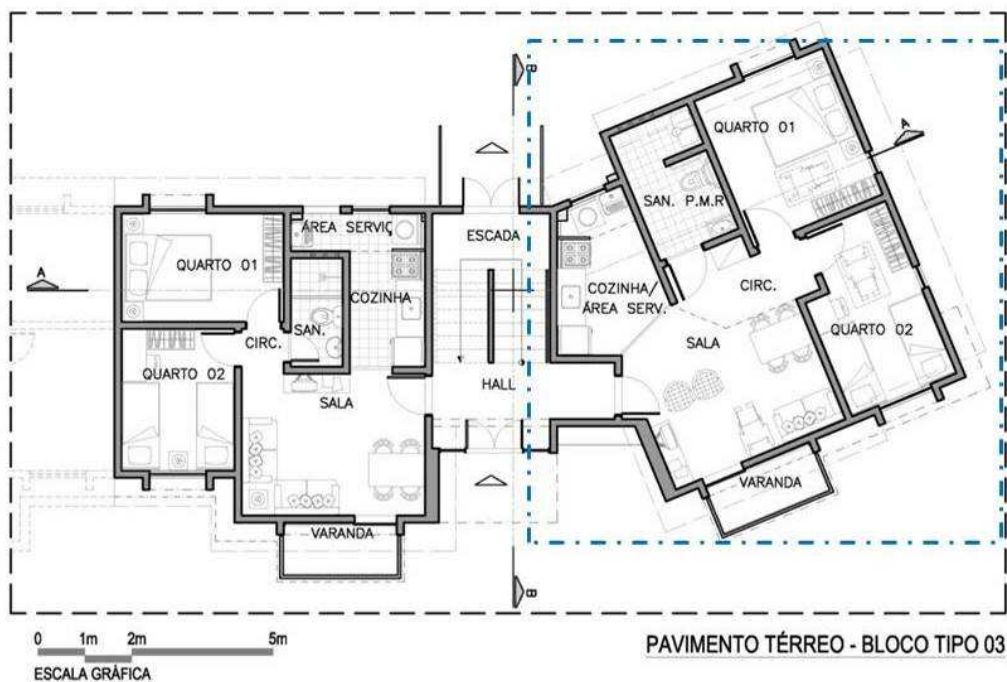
Planta do pavimento térreo do Bloco Tipo 3. Fonte: FFA.
